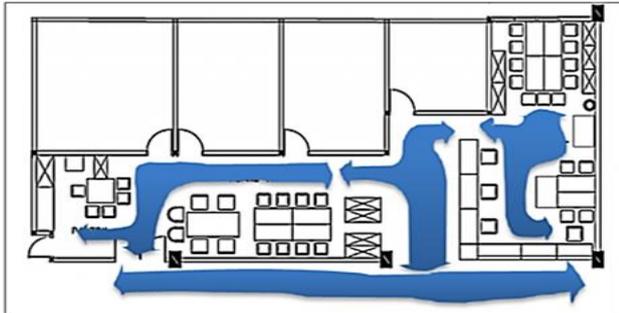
Denah layout Ruang Administrasi Departemen Arsitektur Unhas Gowa
